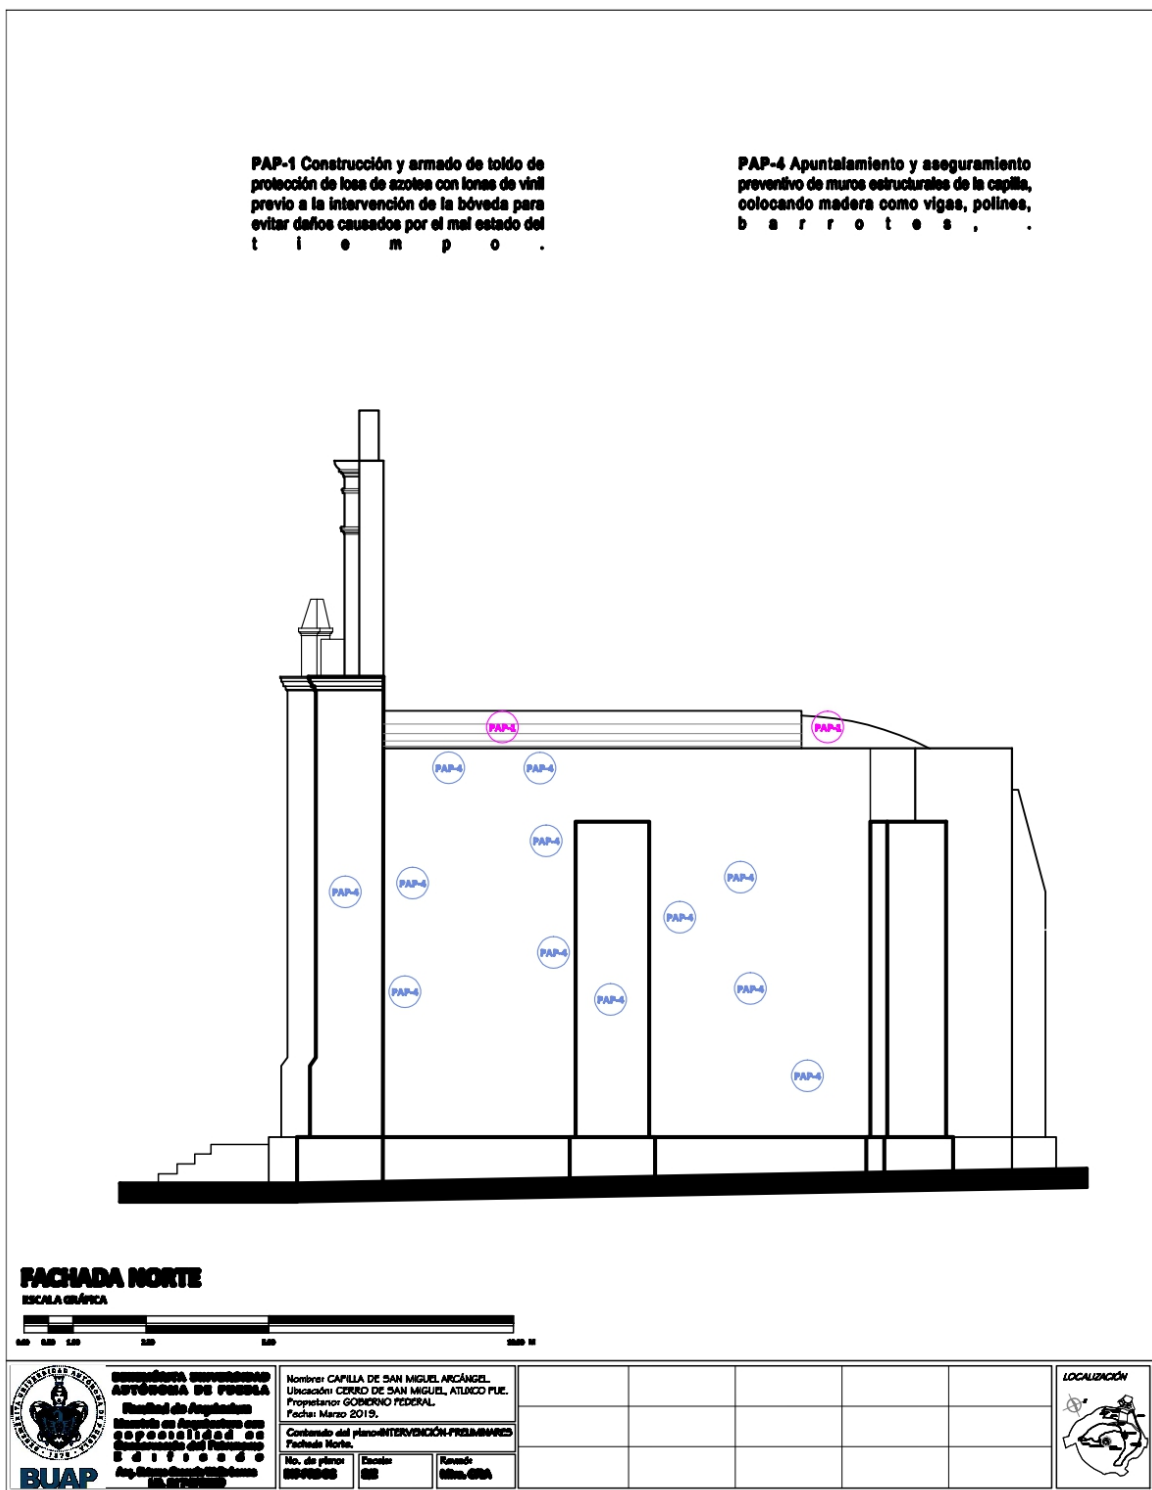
Plano 1 de intervención con acciones preliminares en la fachada norte.
